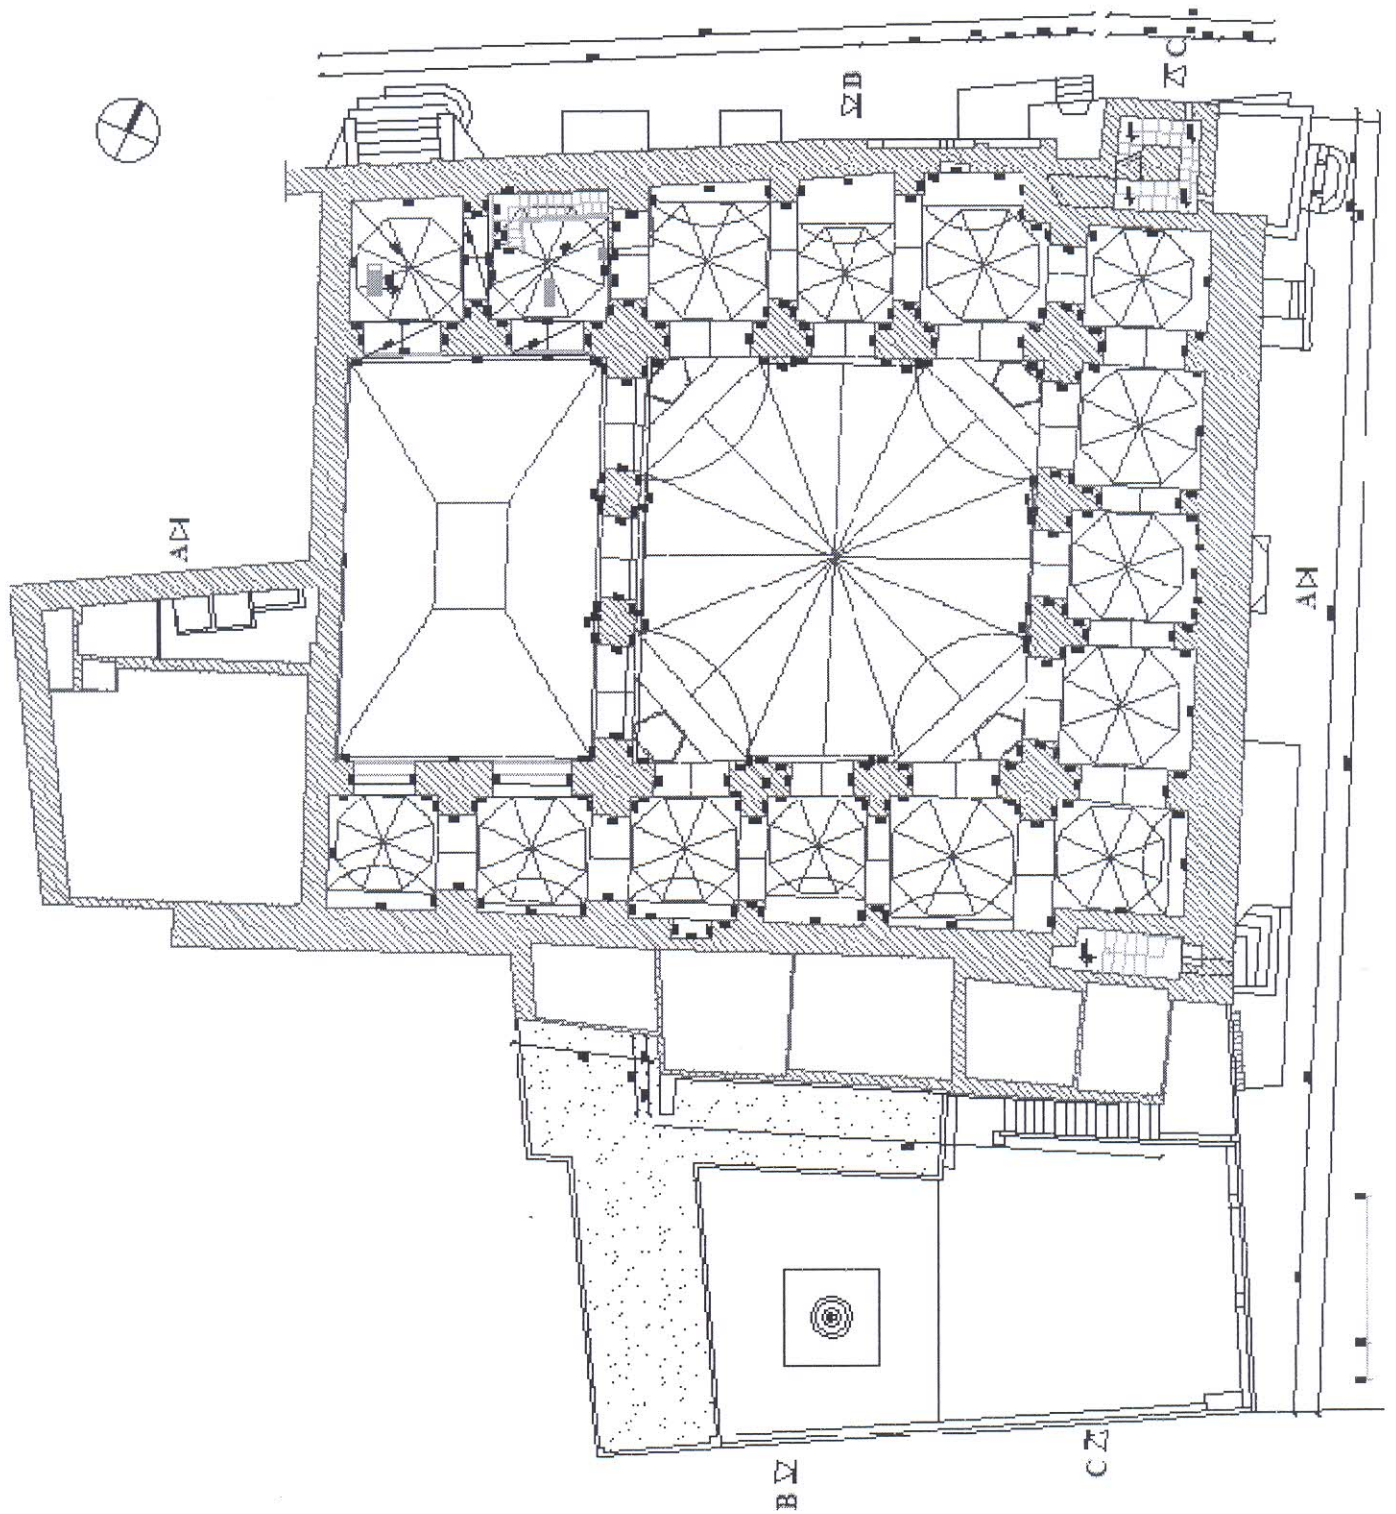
Plan Mezzanine de La mosquée Ali Betchine
